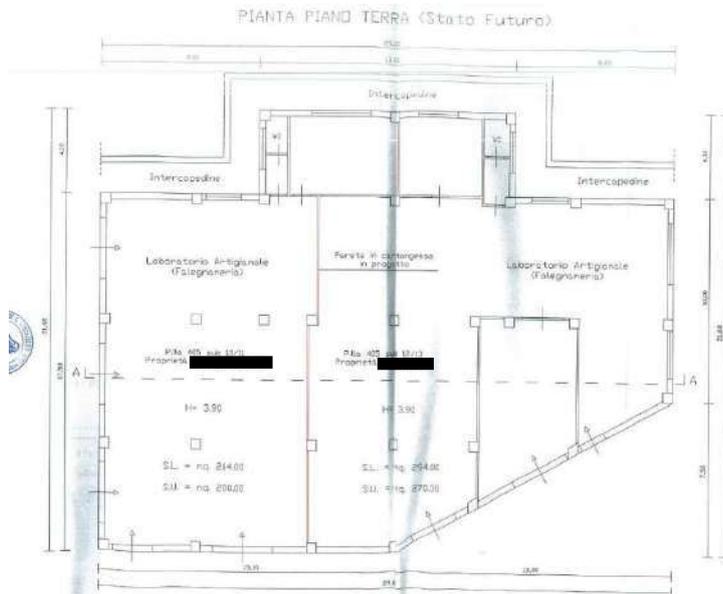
Estratto dalla DIA a firma Geo. [REDACTED] - SETT 2009
